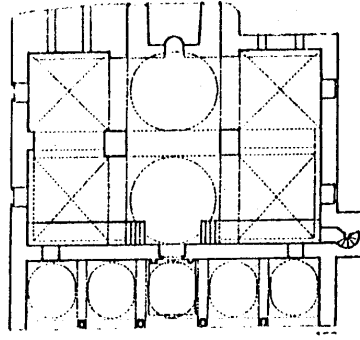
مسقط أفقي لمسجد السيدة بالمنستير بتونس (عن : Marçais) .
